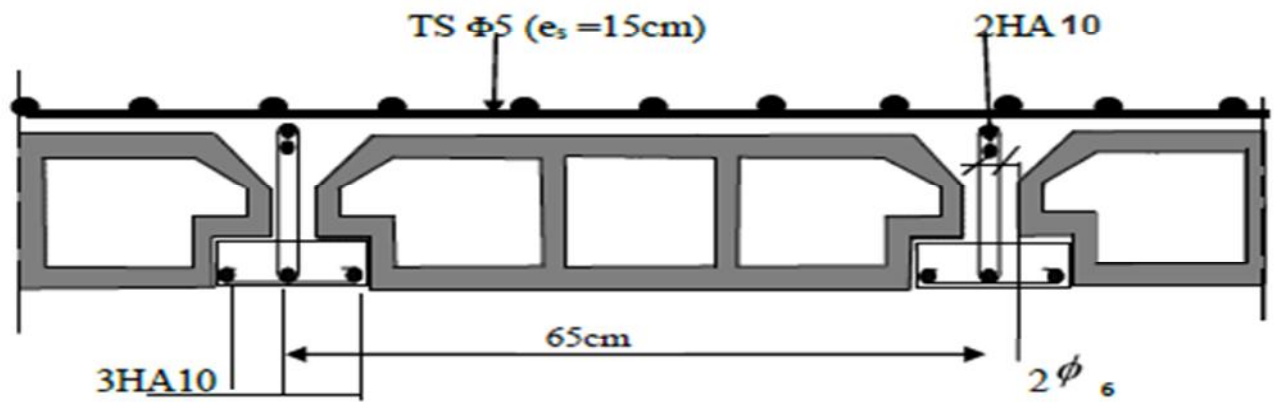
Plan de ferrailage du plancher en corps creux.
